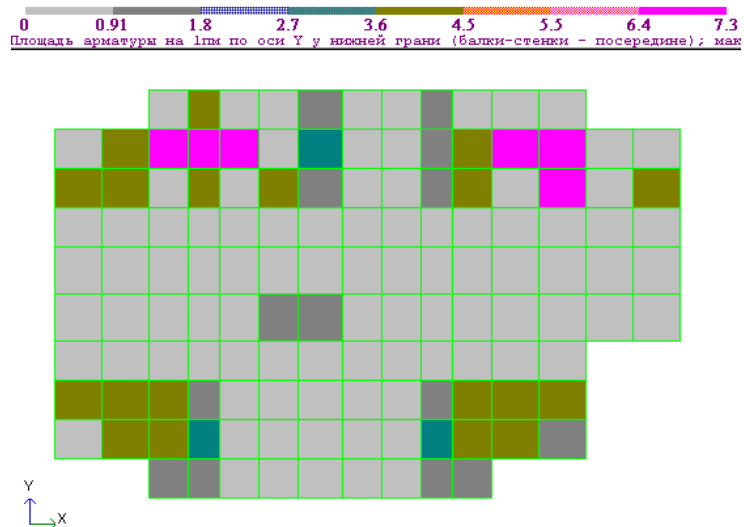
Площадь арматуры на 1 п/м по Оси Y у нижней грани
